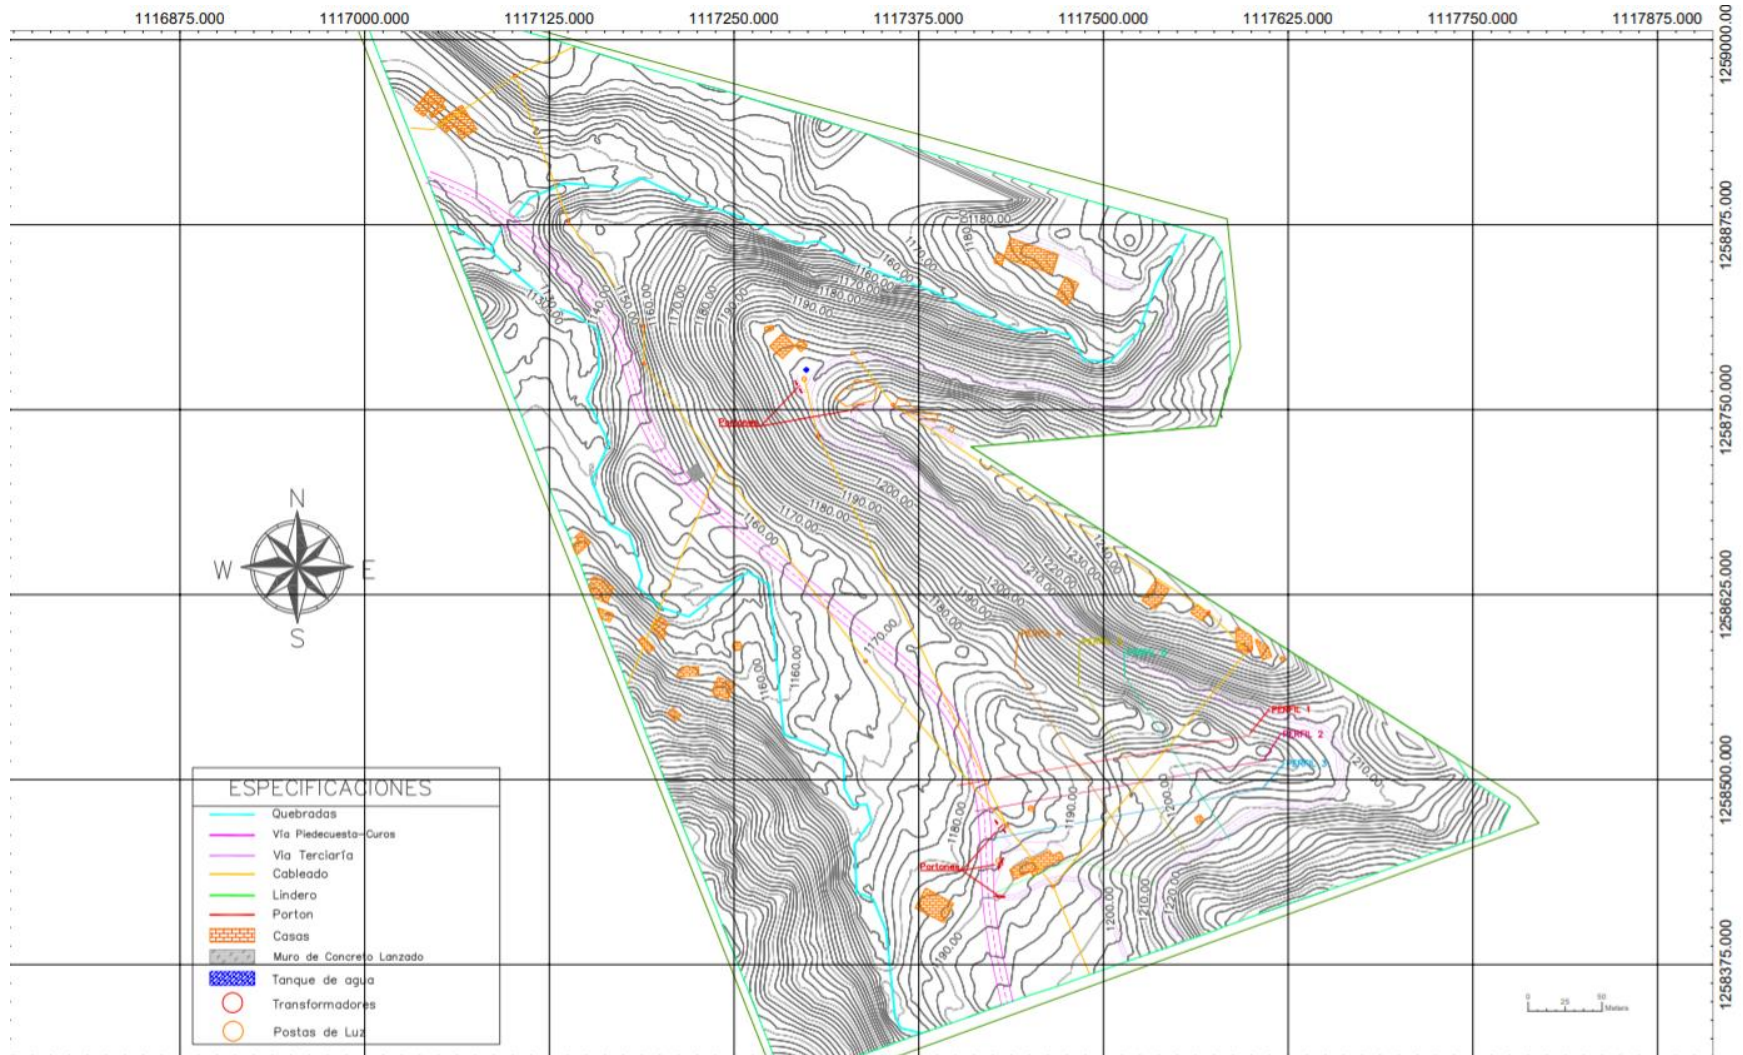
Plano elaborado a base de información generada en Pix4DMapper, Fuente: Civil3D - Propia
